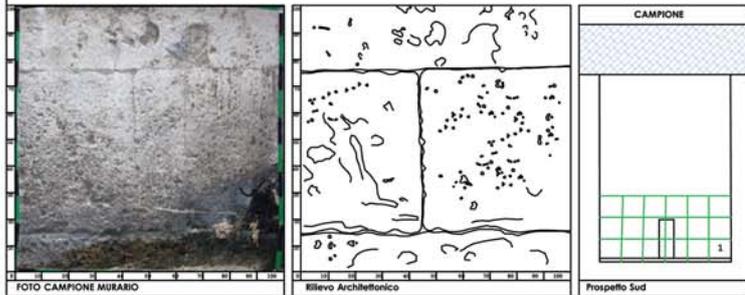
FOTO CAMPIONE MURARIO Rilievo Architettonico Prospetto Sud
